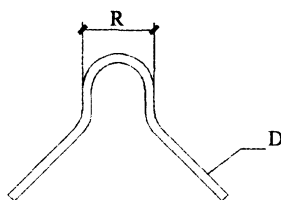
楼梯踏步护角鼻梁剖面图
